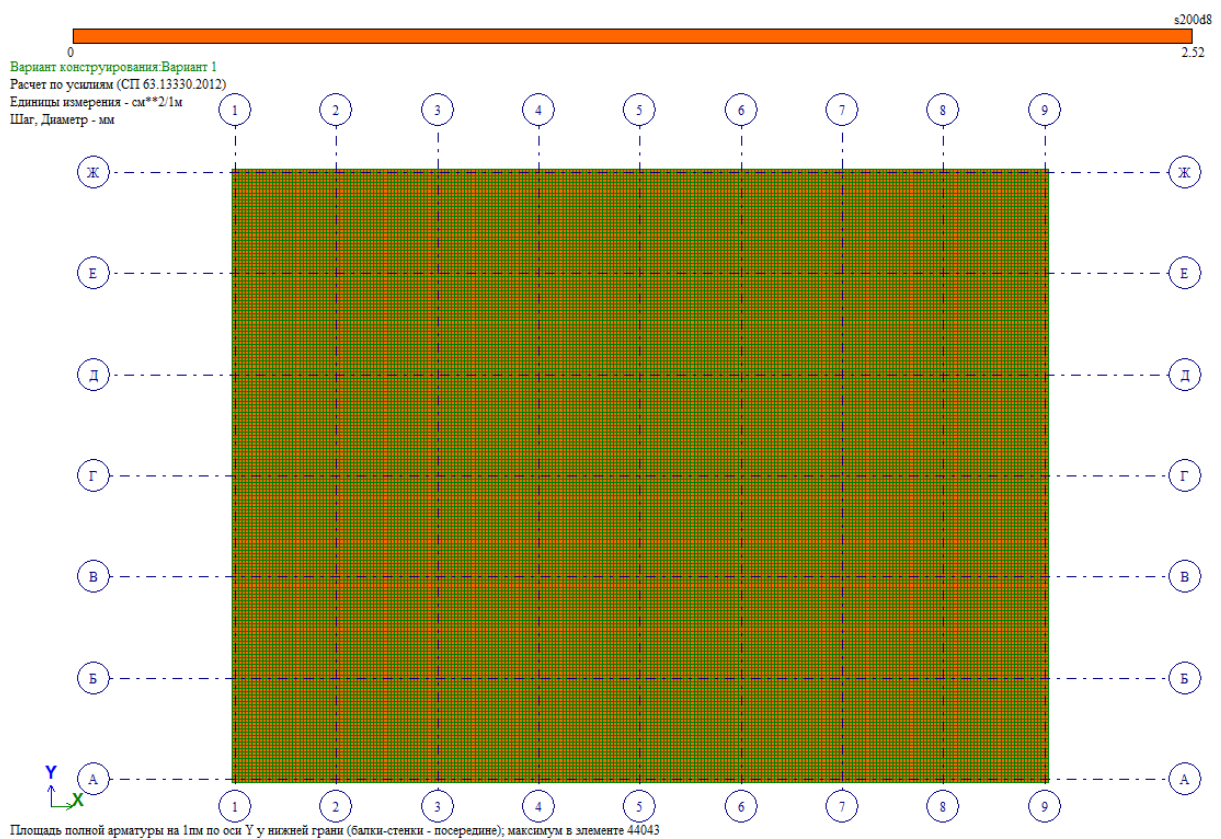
Нижнее продольное армирование по оси Y
